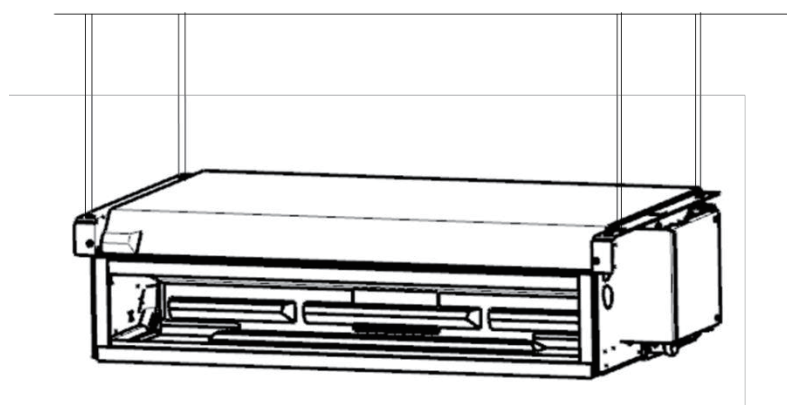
Schéma d'une installation au plafond avec unité dissimulée
